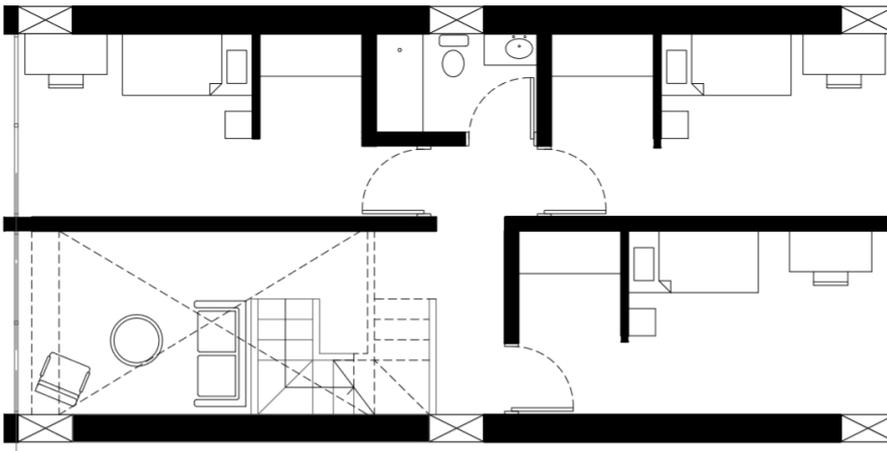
Primera planta tipo módulo de habitación. Elaboración propia.
